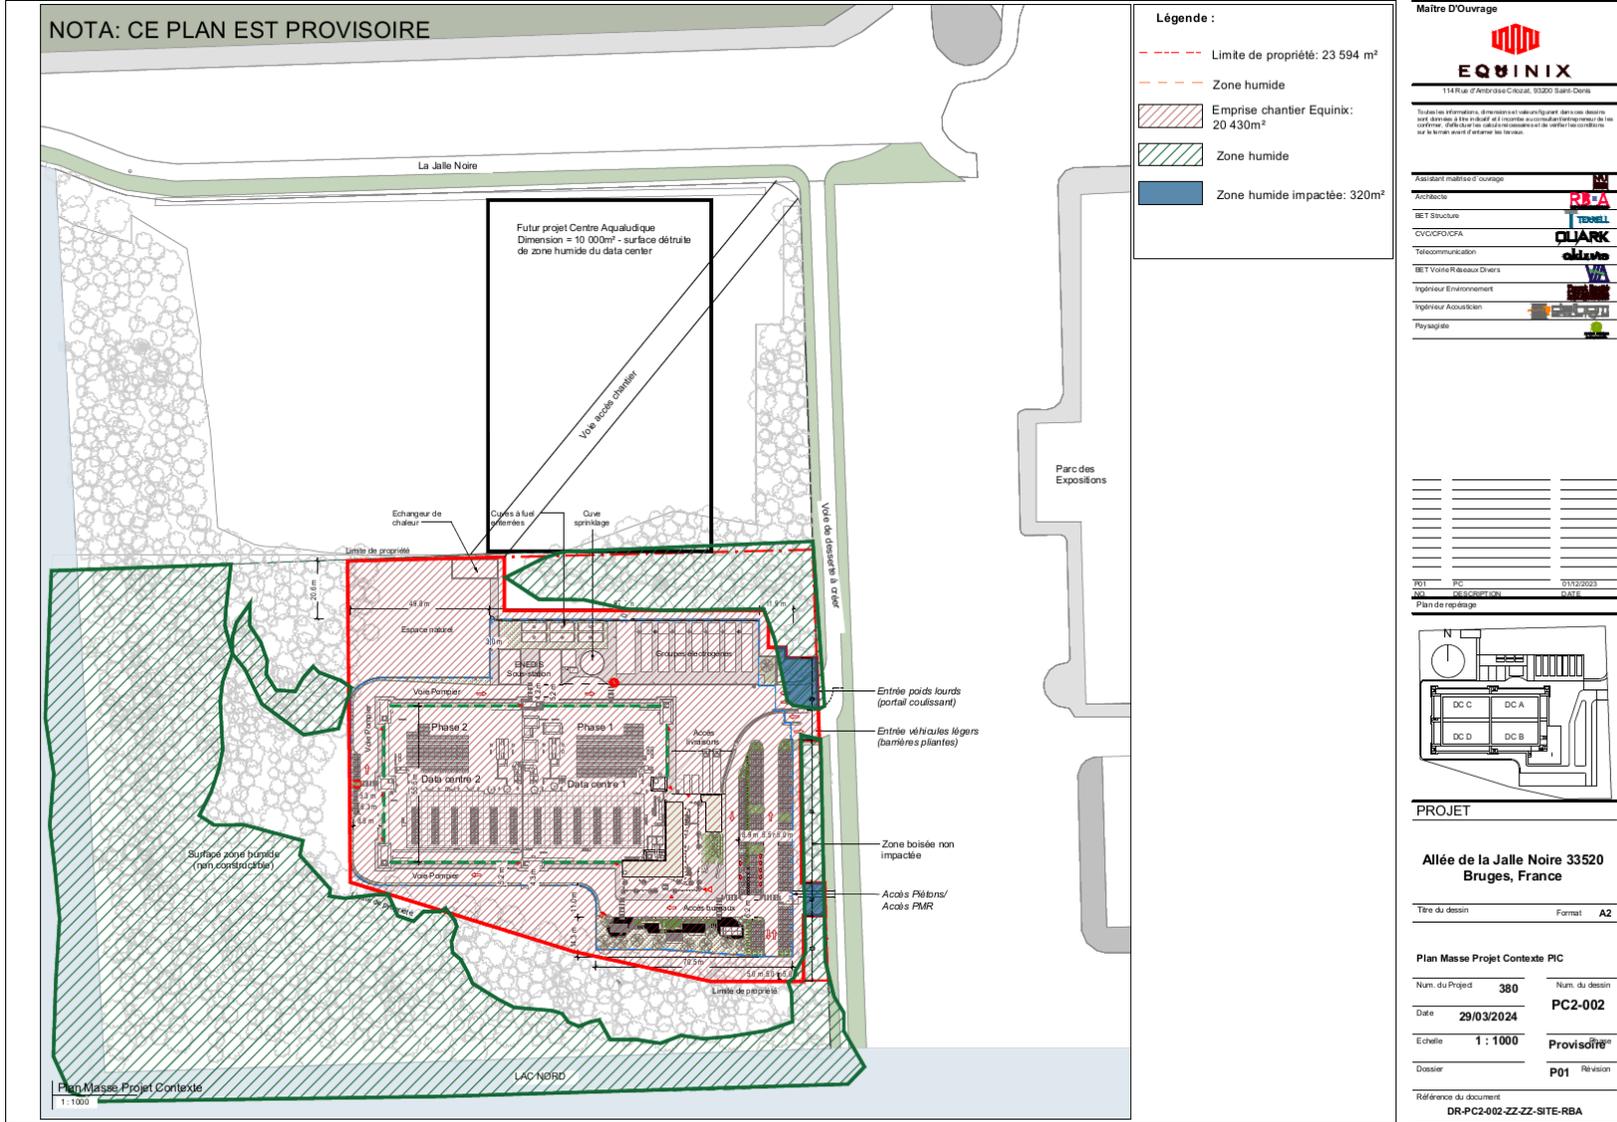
Plan d'Installation de chantier - Data Center (Equinix)
